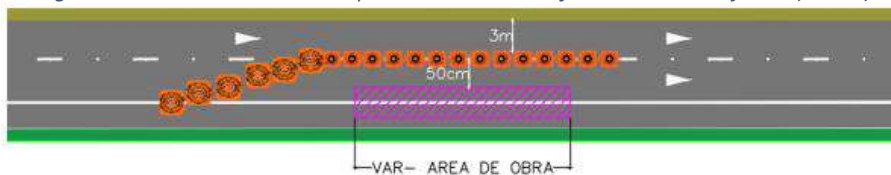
Posicionamento de dispositivos de canalização – Pista com 2 faixas (caso 2)
